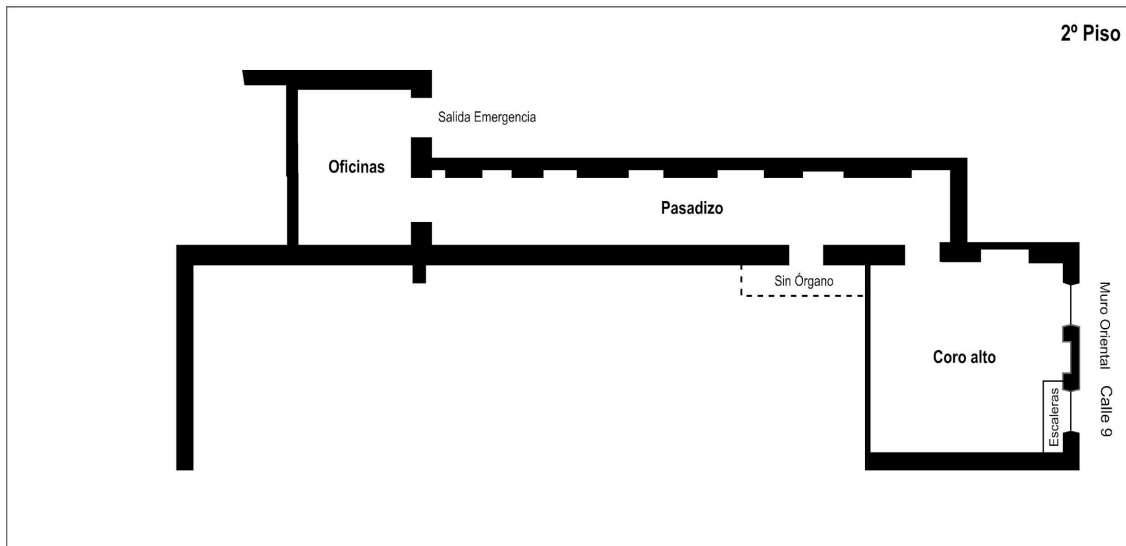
Plano de la segunda planta del Museo de Santa Clara.
